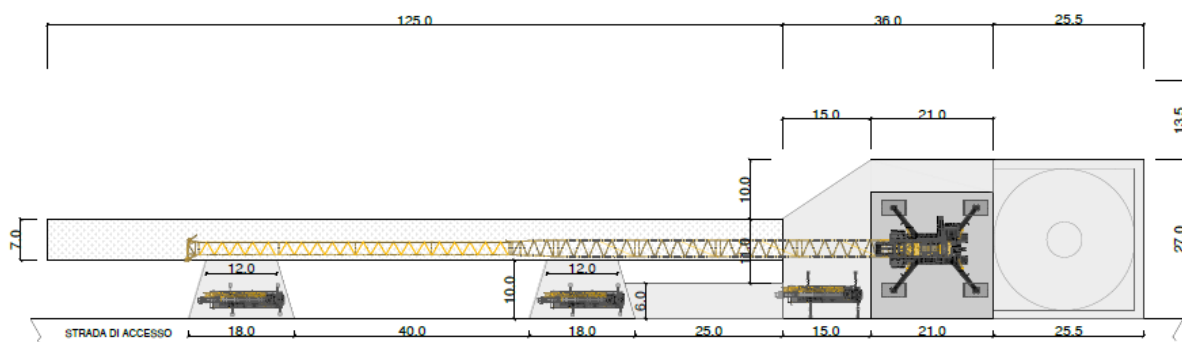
Planimetria piazzola (configurazione "Just in Time") in fase di cantiere
